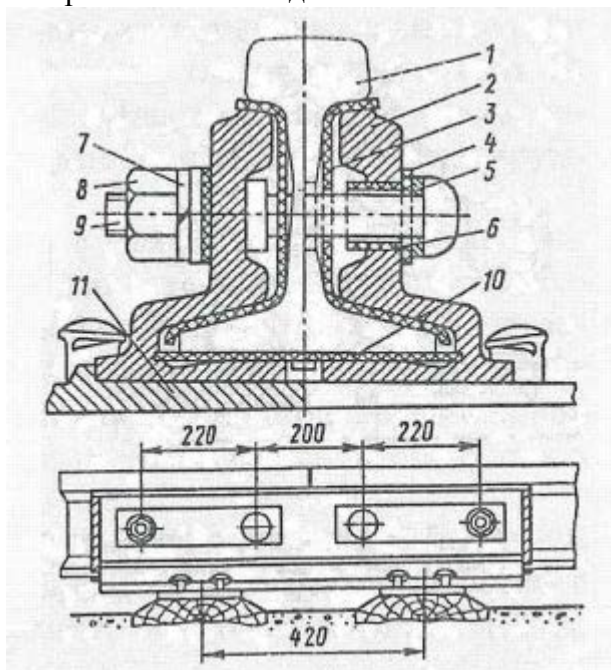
Изолирующий стык: 1-рельс, 2-накладка, 3-прокладка боковая, 4-полиэтиленовая планка под болты, 5-металлическая стопорная планка, 6-изолирующая
